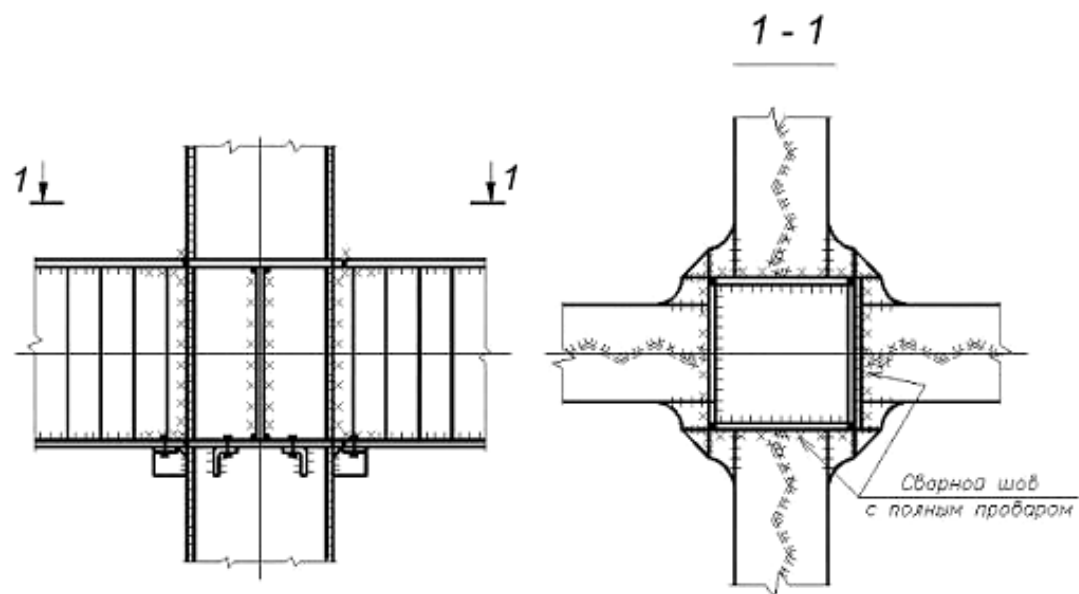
Сварной рамный узел каркаса
